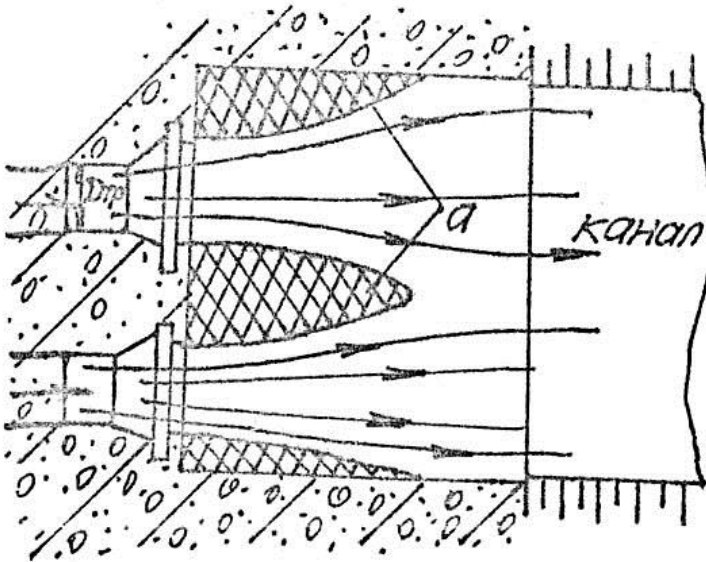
Схема в плані видовипусної споруди для зрошувального каналу
